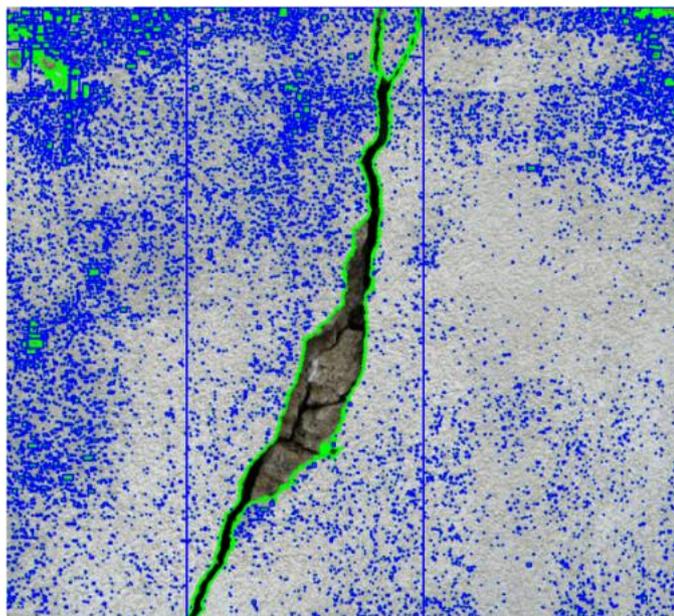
Estrutura de concreto armado em estado não ideal com três processamentos diferentes.
